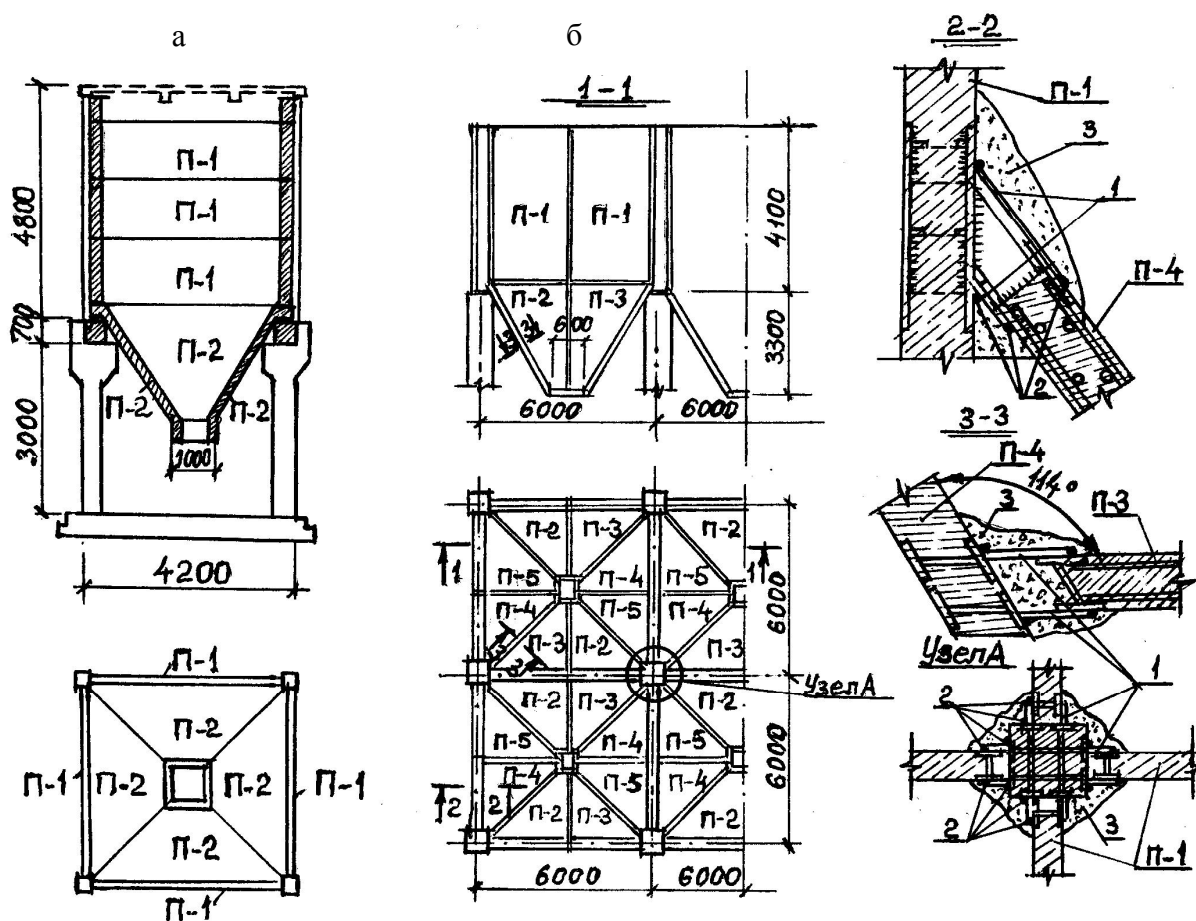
Компонка сборных железобетонных элементов бункера: а – разрезание на целые плоскости; б – разрезание на составные элементы; 1 – стальные планки; 2 – монтажные швы; 3 – цементно-песчаная стяжка
